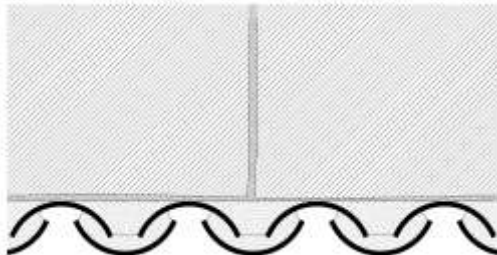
| Detalhamento construtivo de empena revestida em telha cerâmica capa-canal, com sobreposição de telhas em fiadas côncavas e convexas e sem argamassas entre as fiadas das telhas. (desenho do autor)
